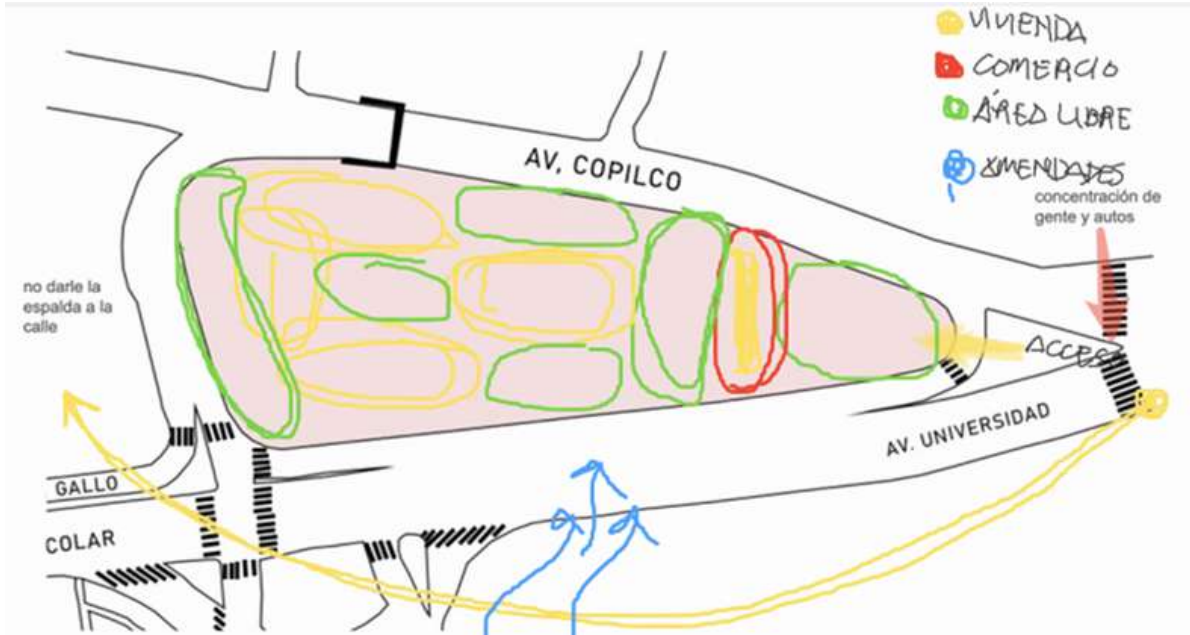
Primeras propuestas de diseño. Fuente: Autoría propia.
